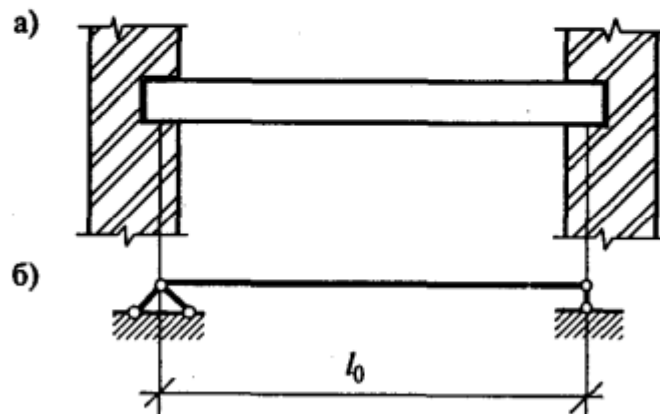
Вариант опирания железобетонной балки (плиты) на кирпичные стены: а) конструктивная схема; б) расчетная схема
